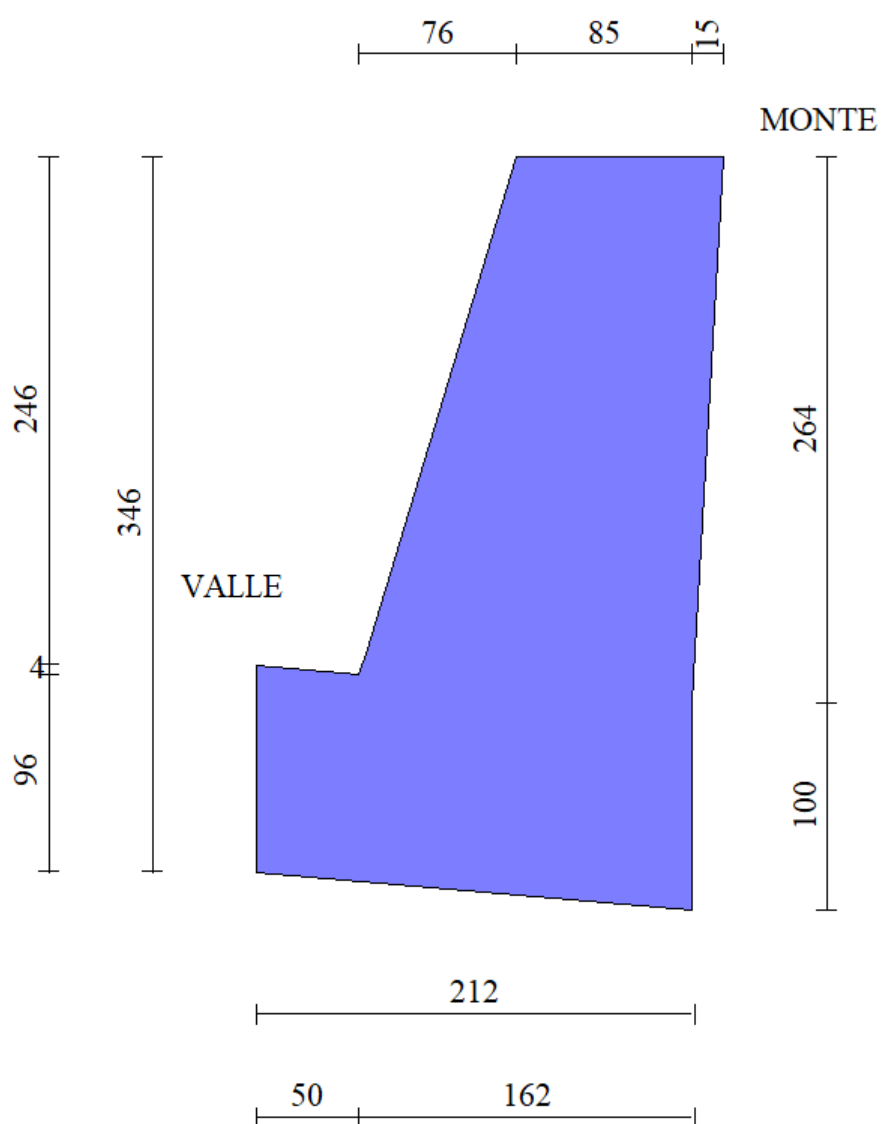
Estratto dal software di calcolo MAX 16.0 – Geometria di modellazione in sezione
